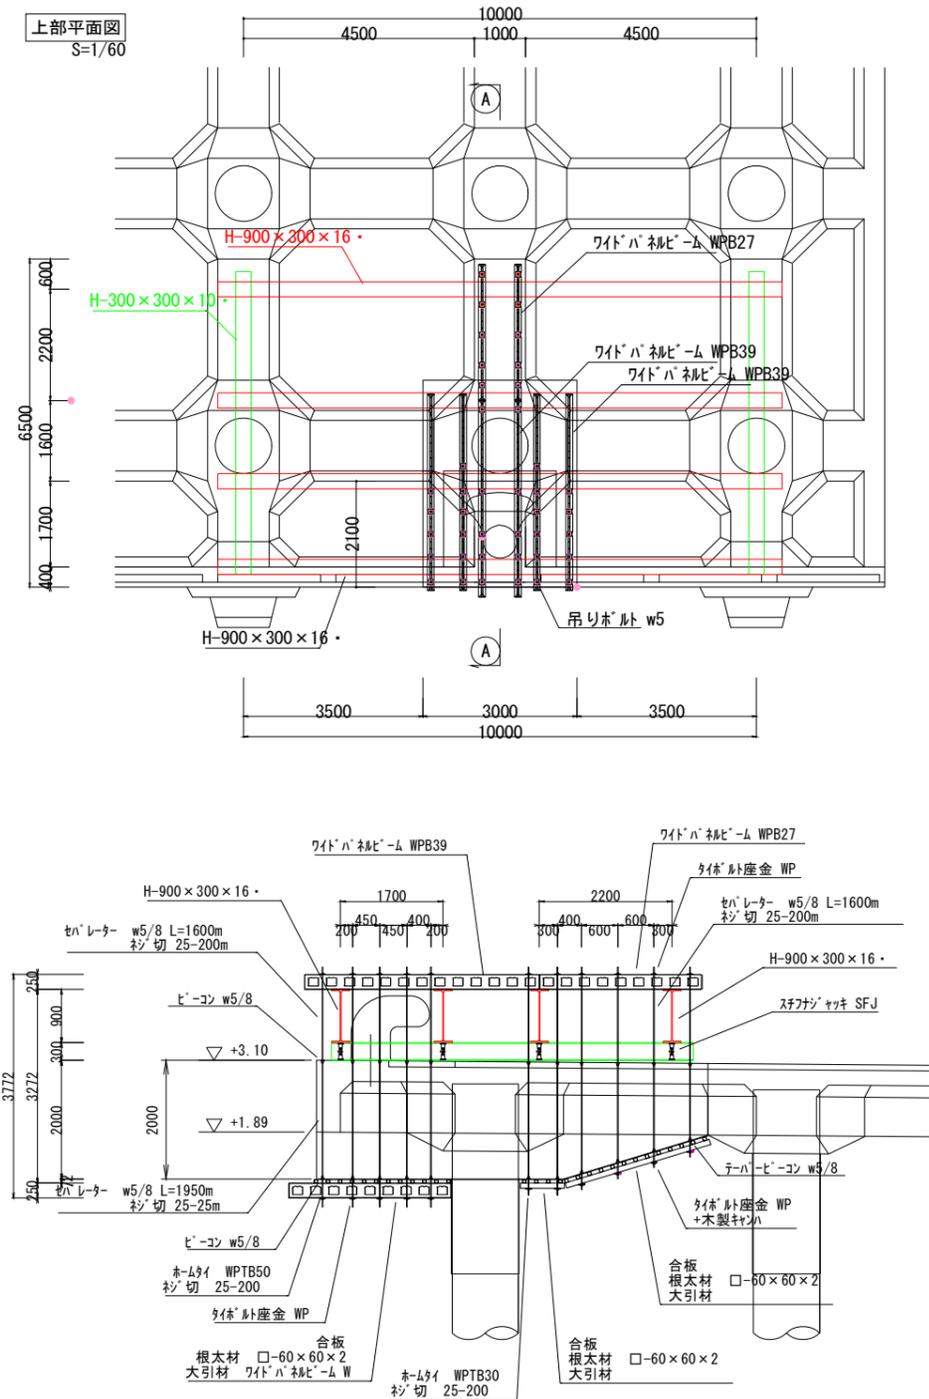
吊足場及び吊支保の平面図(上)、側面図(下) 検討案
